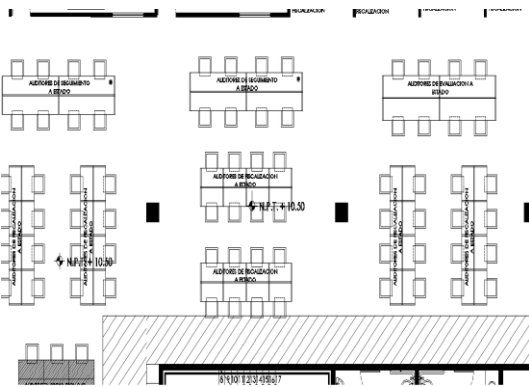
Vista en planta de área de Auditores de evaluación y fiscalización al estado. Autor: Eva Zavala
